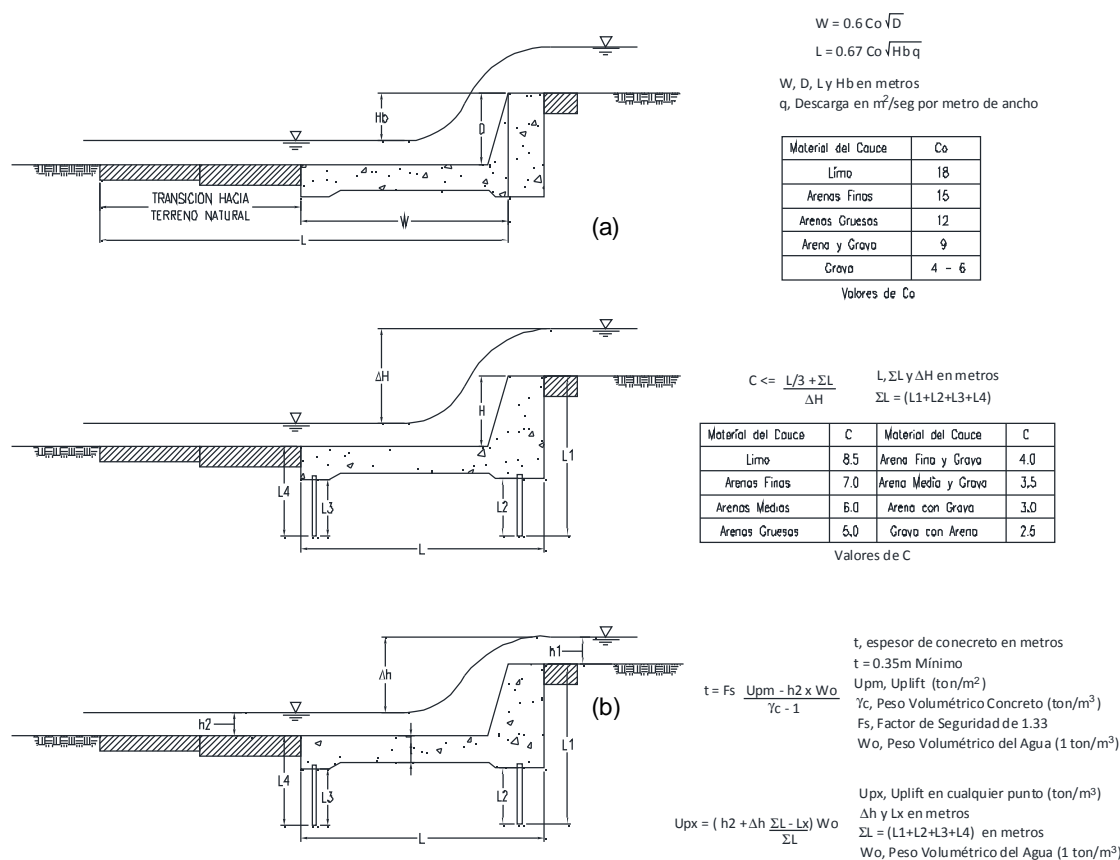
Tipos propuestos de protecciones indirectas mediante muros guardanivel (a) Guardanivel para lechos de suelos firmes o rocosos; (b) Guardaniveles con pilotes para lechos con suelos sueltos (arenosos o de gravas). (SPOP, 2014)
